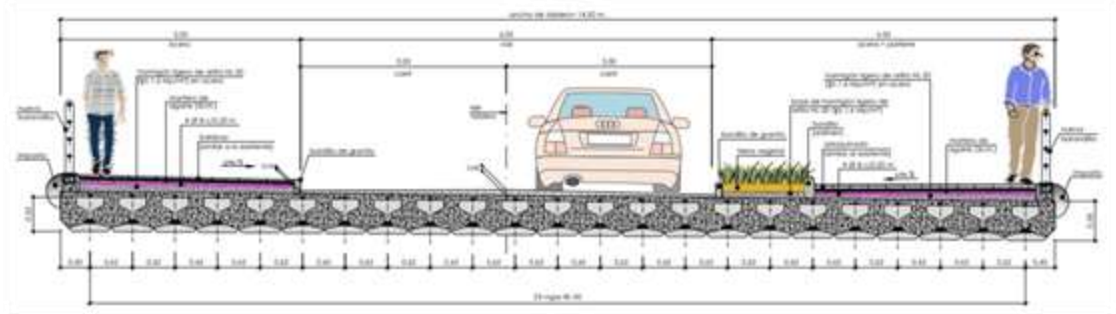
Sección tipo tablero Paso Calle Goikoplaza
